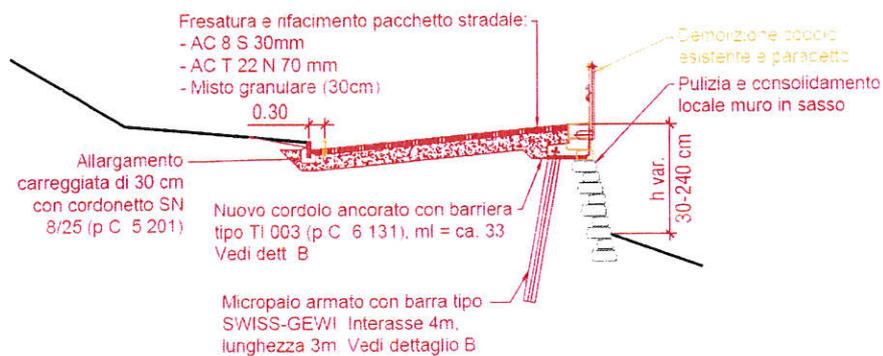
estratto piano P03 sezione tipo intervento muro esistente in pietra
